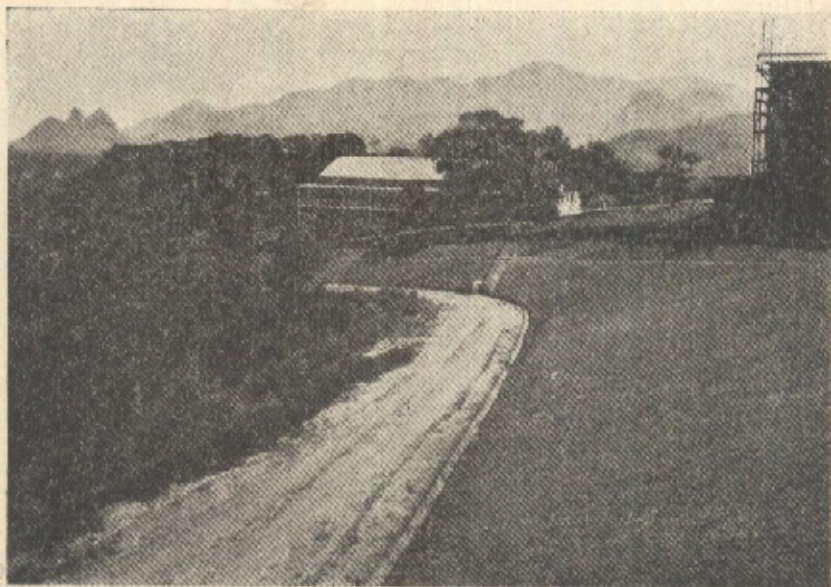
Panorama visto do alto de Curupaity. Nota-se o muro de cimento armado que separa o hospital das propriedades do Tanque, Jacarepaguá.
